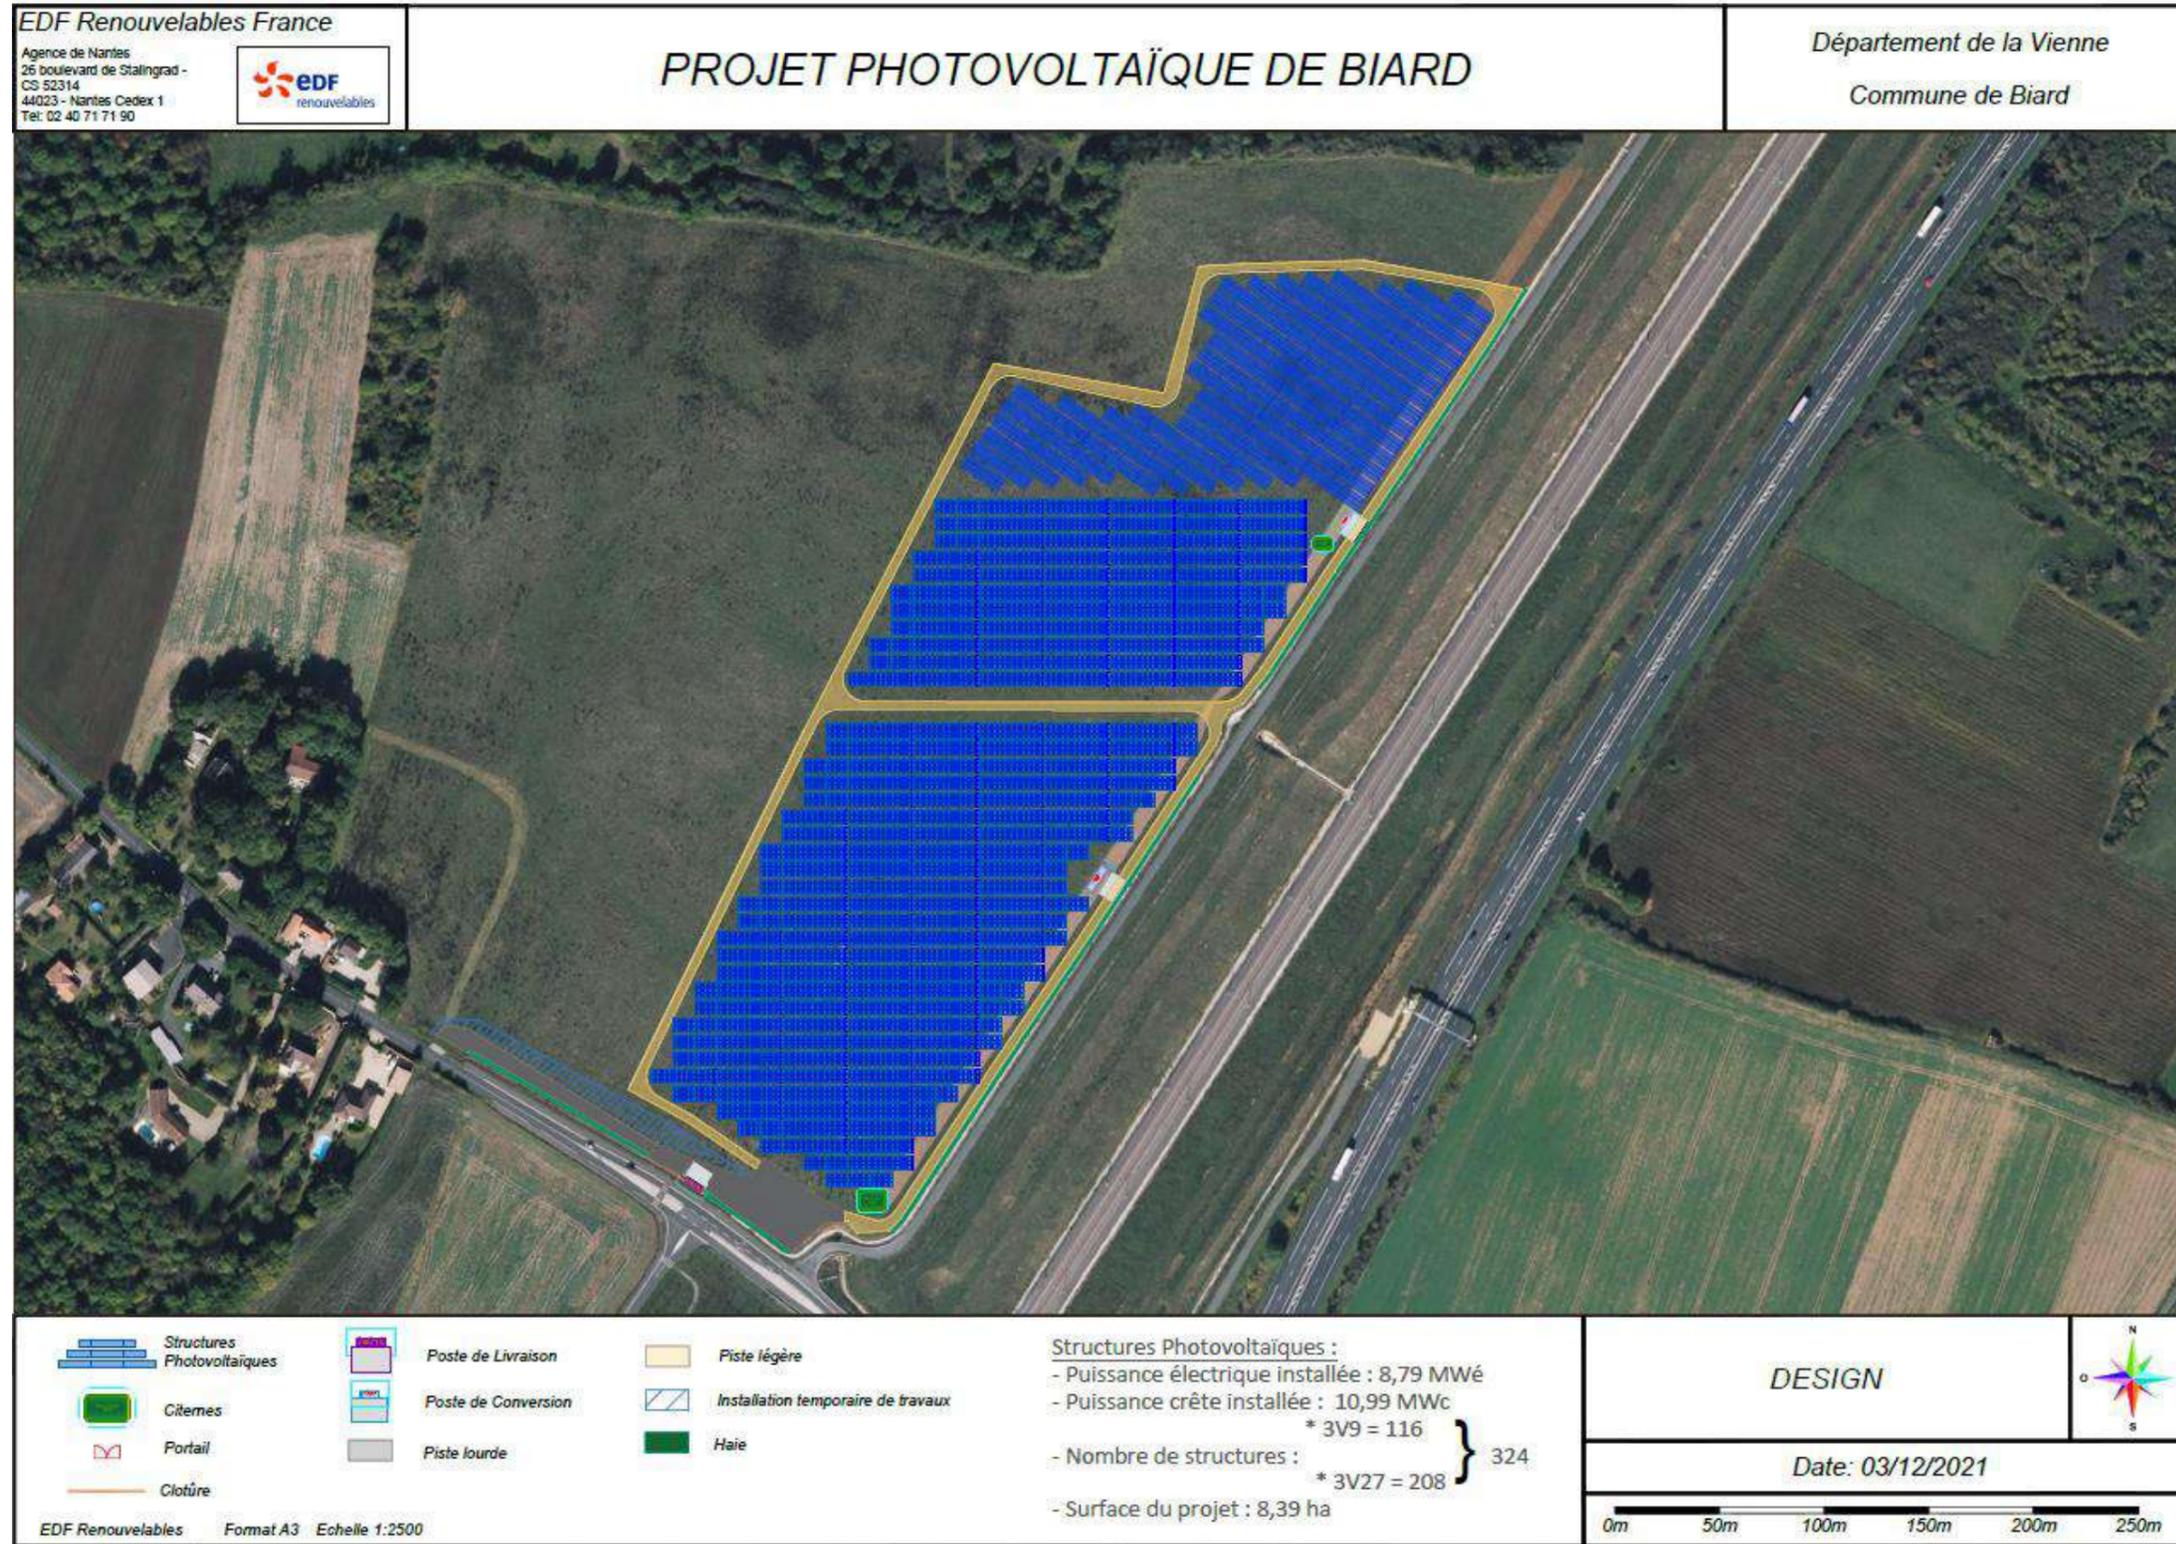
Plan de masse du projet (source : EDF Renouvelables France)
